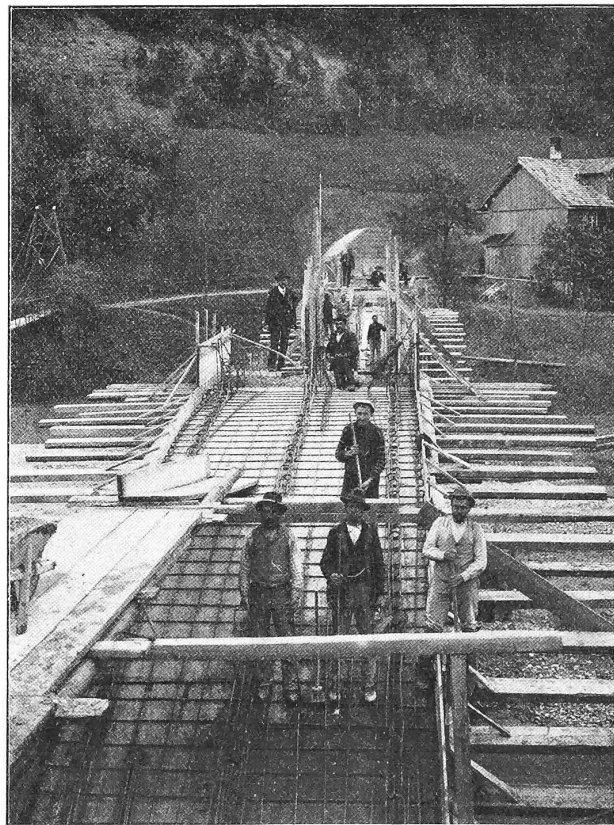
Draufsicht auf die Gerüste mit den Eiseneinlagen für die Längsträger.
